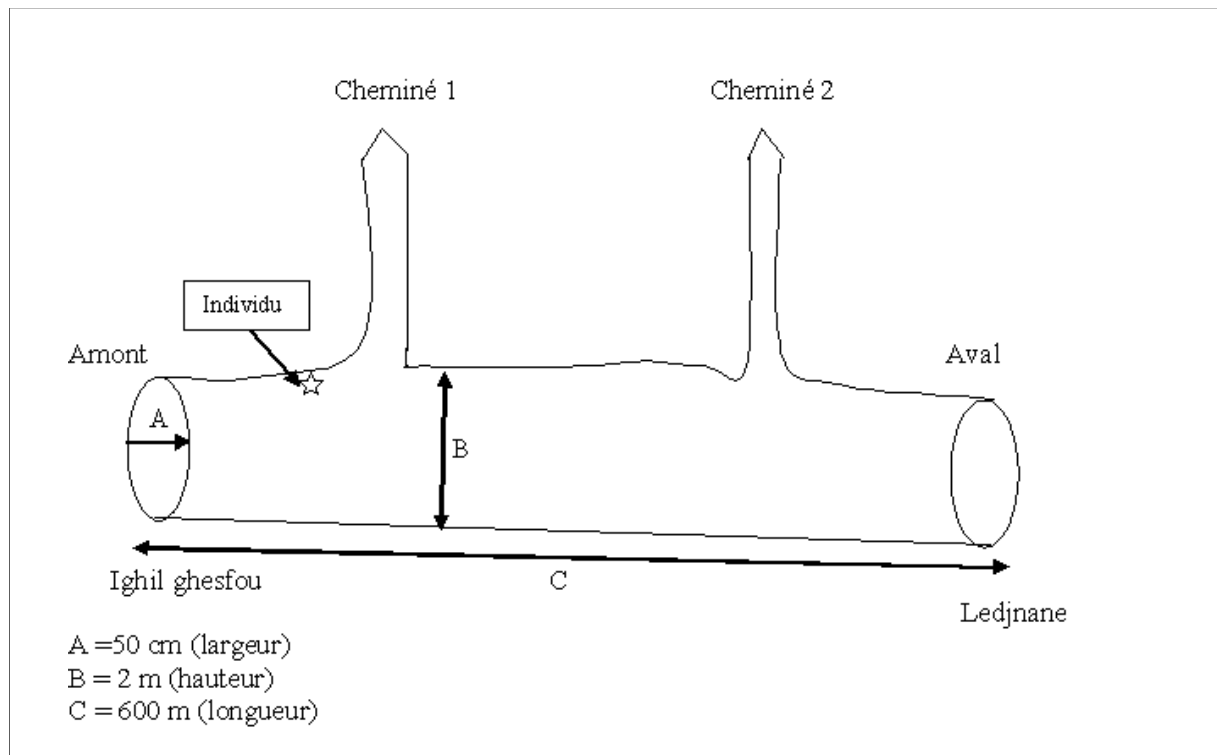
schéma explicatif pour le tunnel lehbel « Toudja » (coupe verticale)
